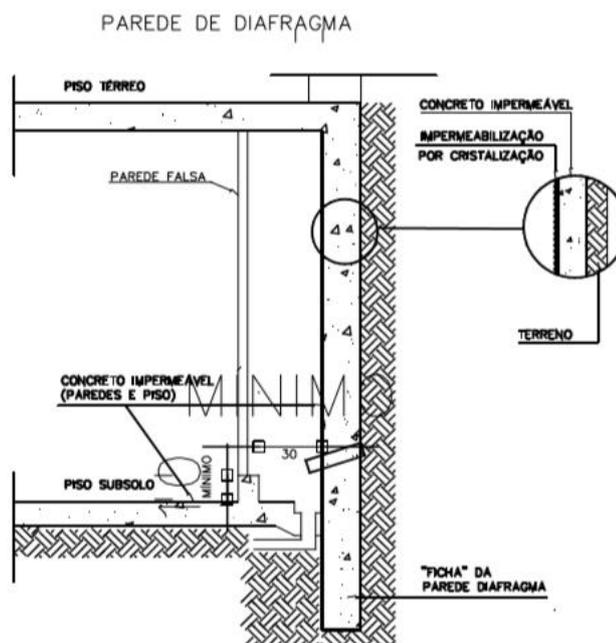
Detalhe de impermeabilização na base das alvenarias externas
